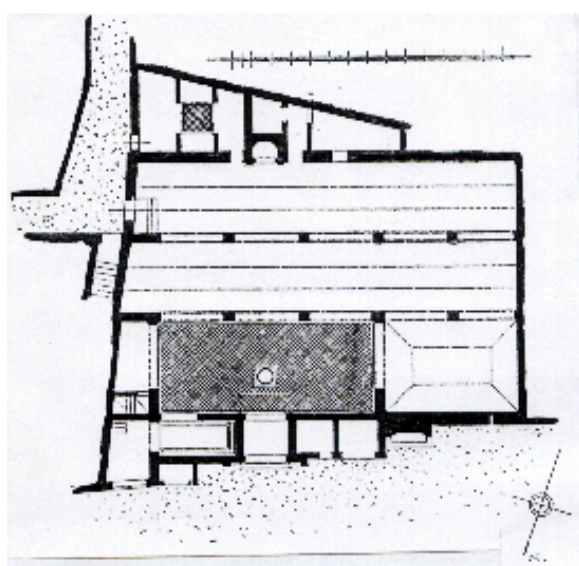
مسقط أفقى لمسجد سيدى بو مدين المريني بتلمسان.
